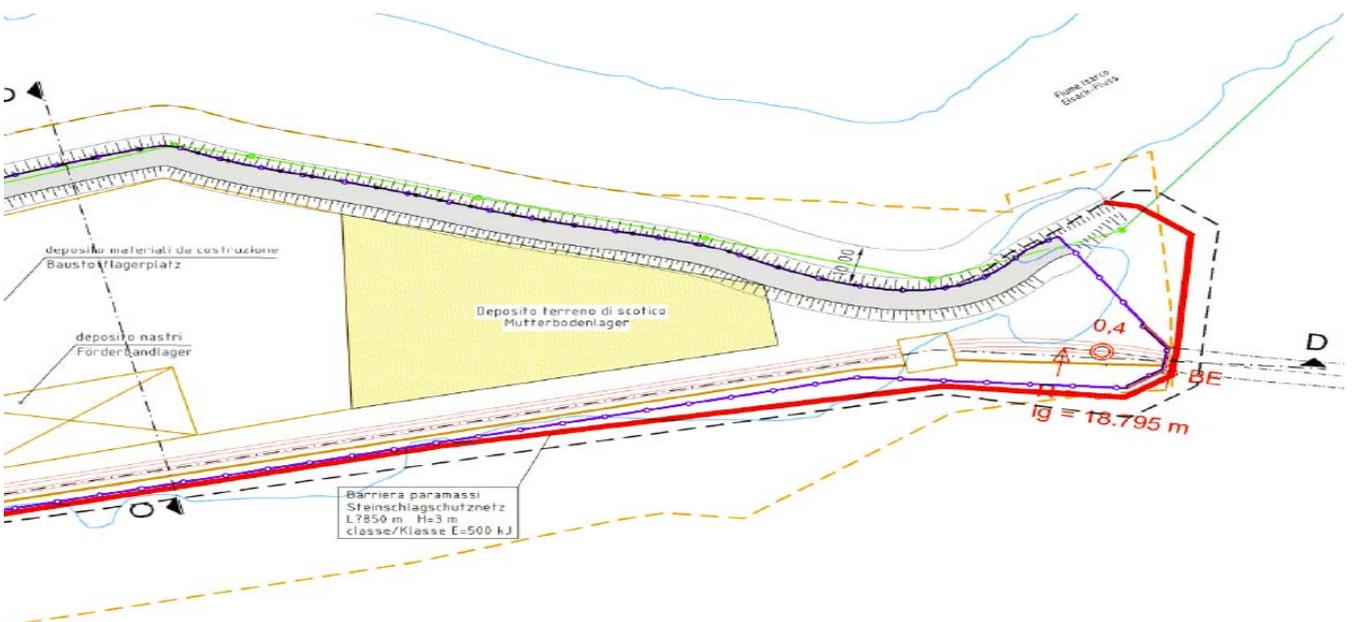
Detail Zwischenlager-Depot bei Baustelle Unterplattner
